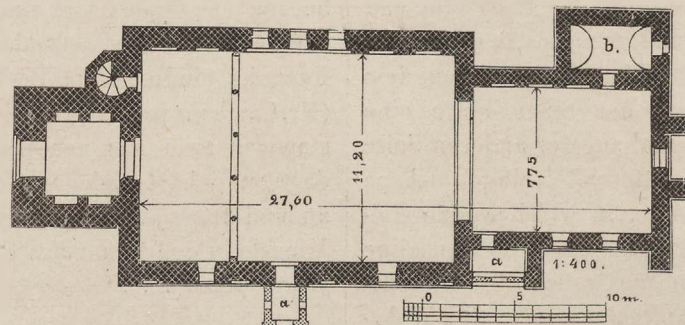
Lalkau. Grundriss der Kirche.
